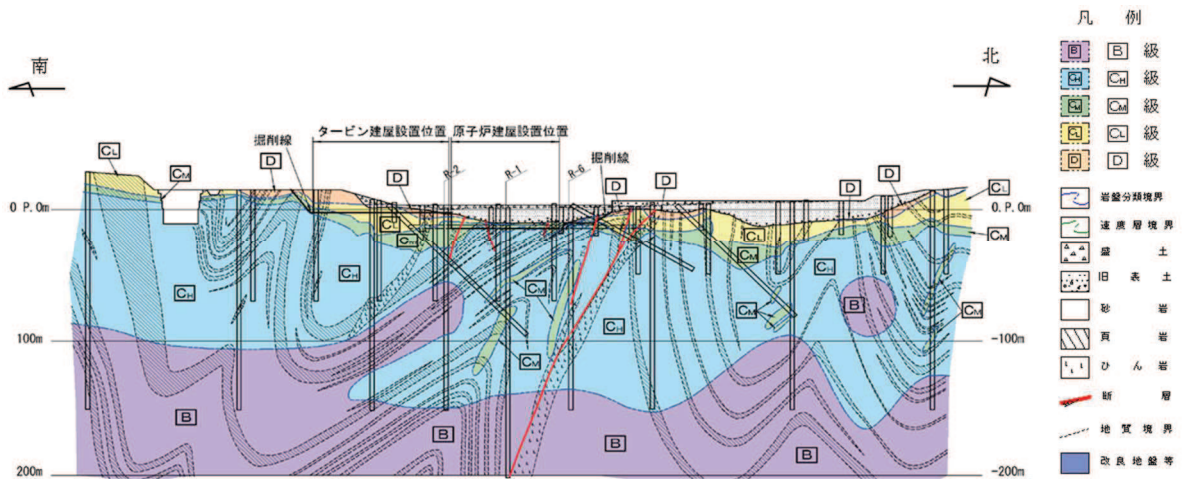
(2) 原子炉建屋の地質断面図 (②-②断面)
